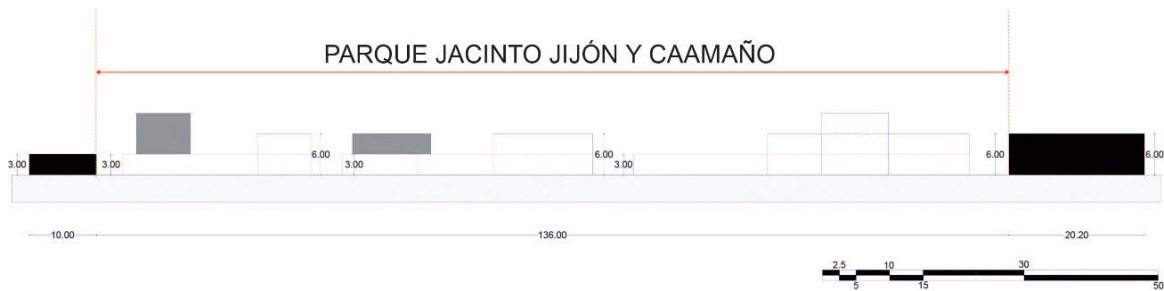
Corte longitudinal P. Jacinto Jijón y Caamaño
